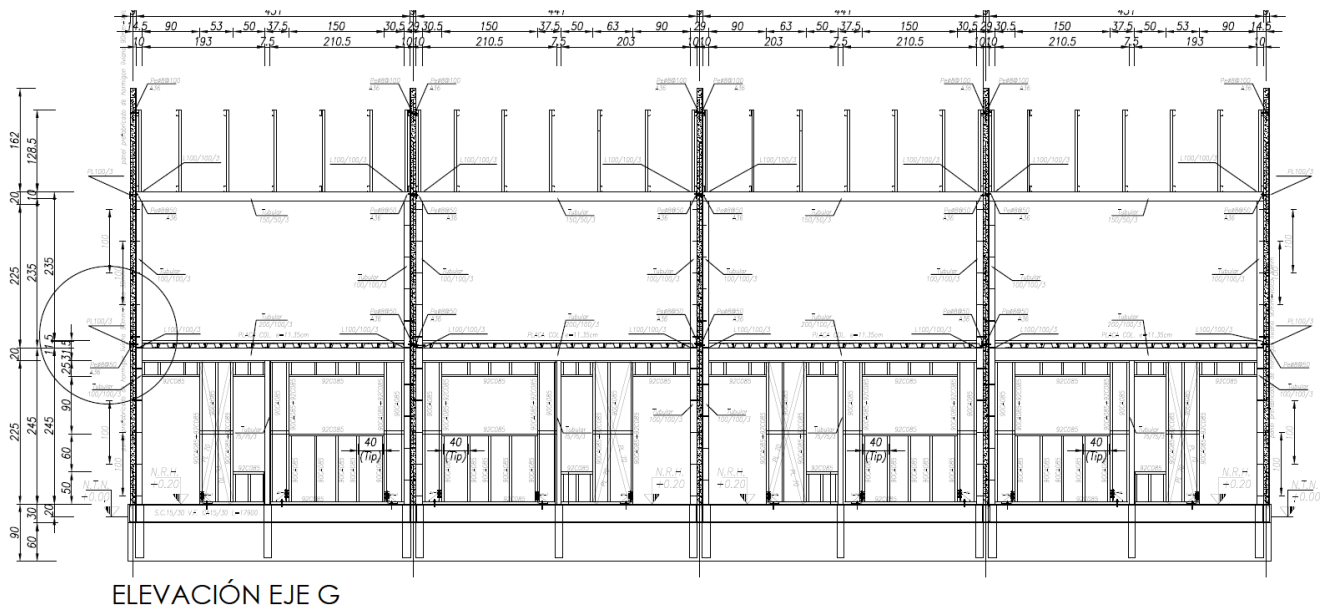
"Corte que muestra relación entre los paneles prefabricados de hormigón liviano y las columnas de acero \square 100x100x3 mm".
